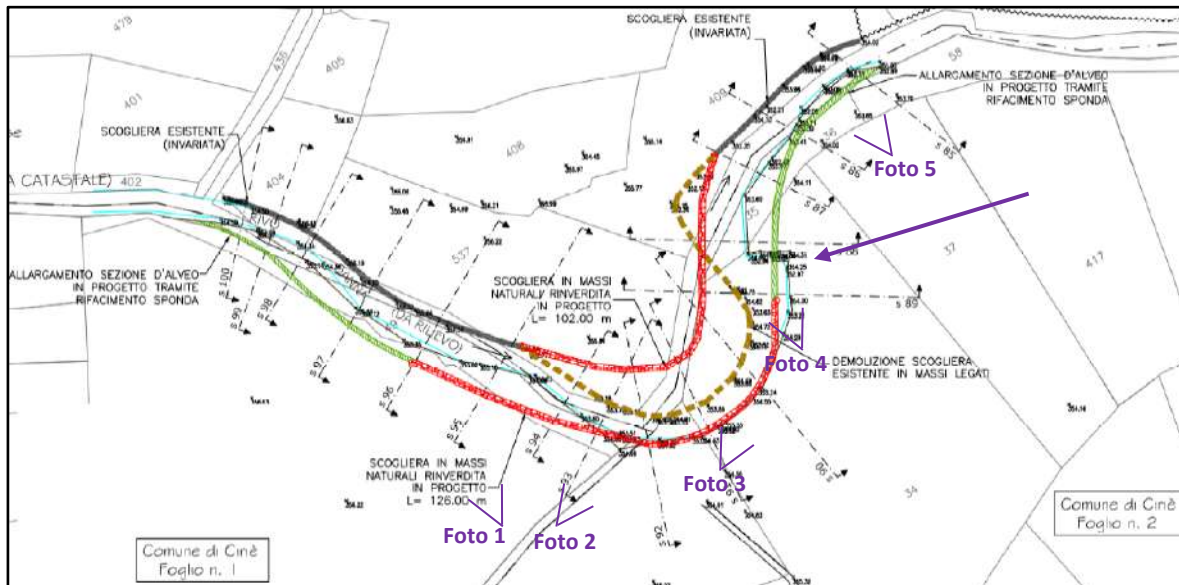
Estratto Planimetria di progetto meandro a monte dello stabilimento Algat (Ing. Vaudagna 2010) con sovrapposizione dell'ubicazione delle foto e settore in forte erosione (freccia viola)
